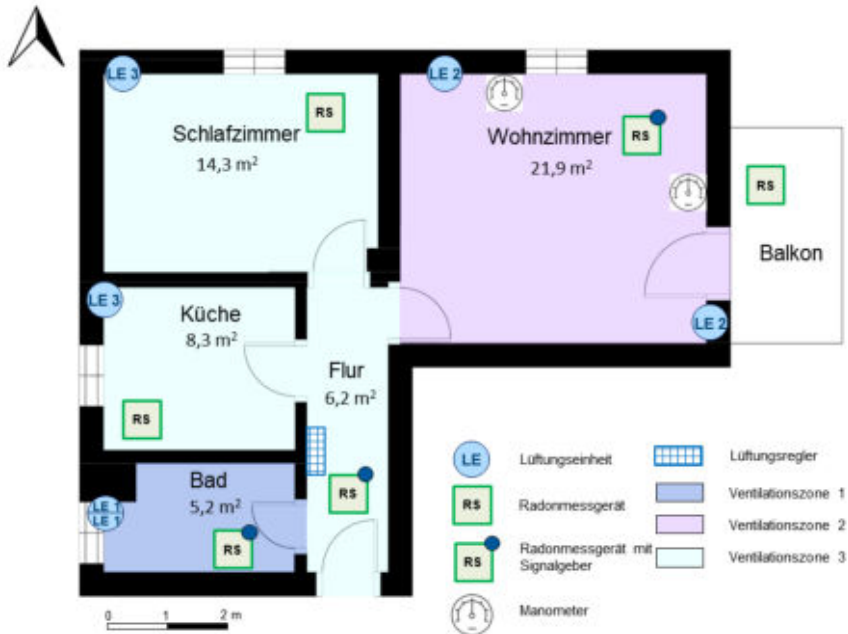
Grundriss der Versuchswohnung mit Positionen der Geräte und markierten Lüftungszone [6]
